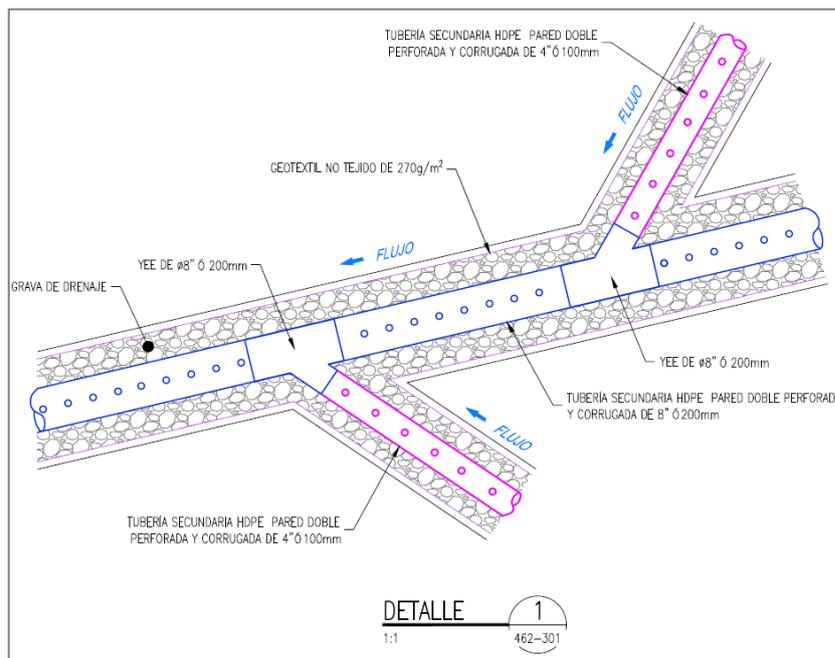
Detalle de instalación de tuberías en sistema de drenaje.
